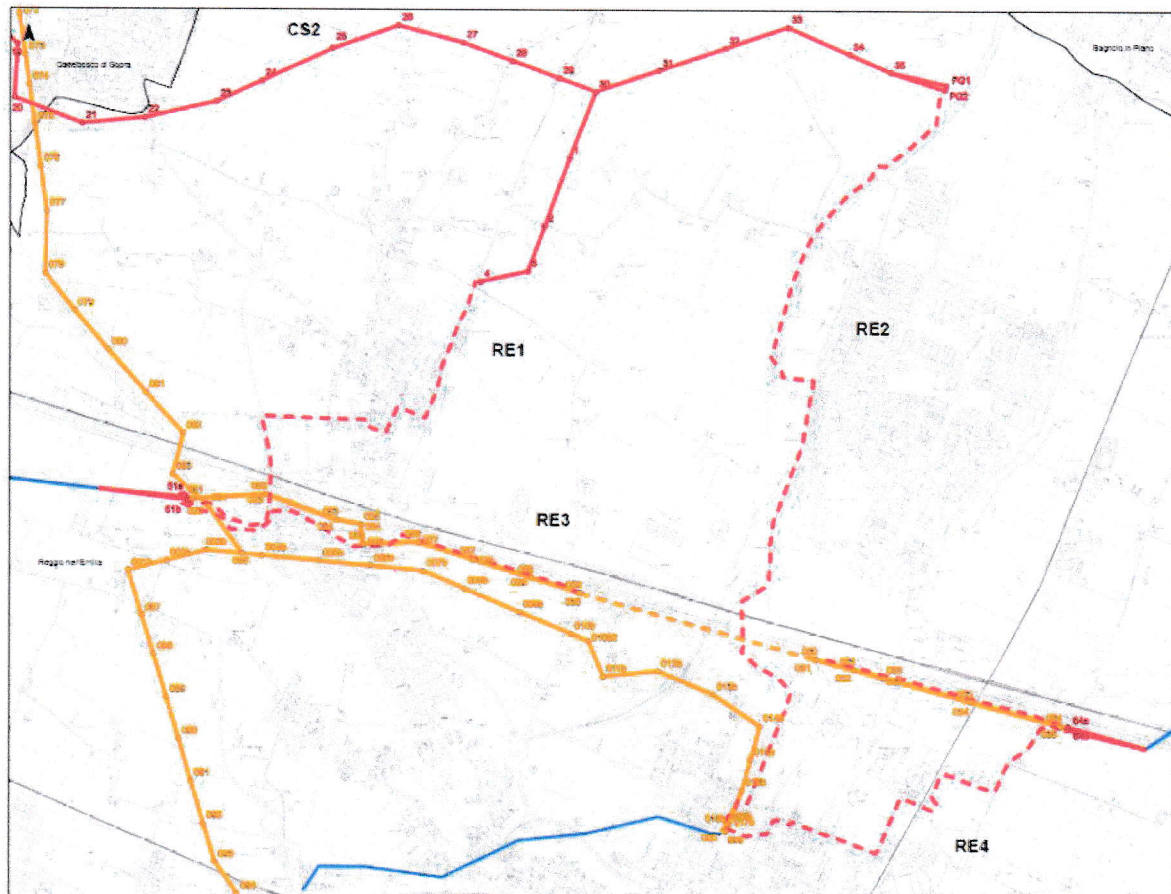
Planimetria progetto 31/01/2021 (tratta da elaborato Terna DU0000006B1937737)
